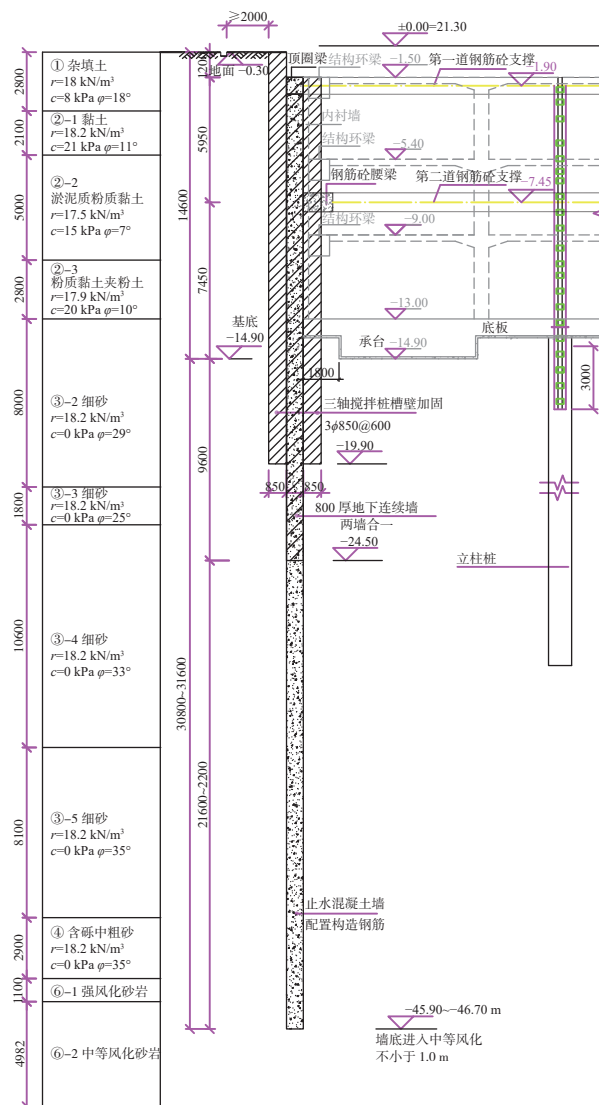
邻地铁侧基坑支护典型剖面图(单位:mm)
